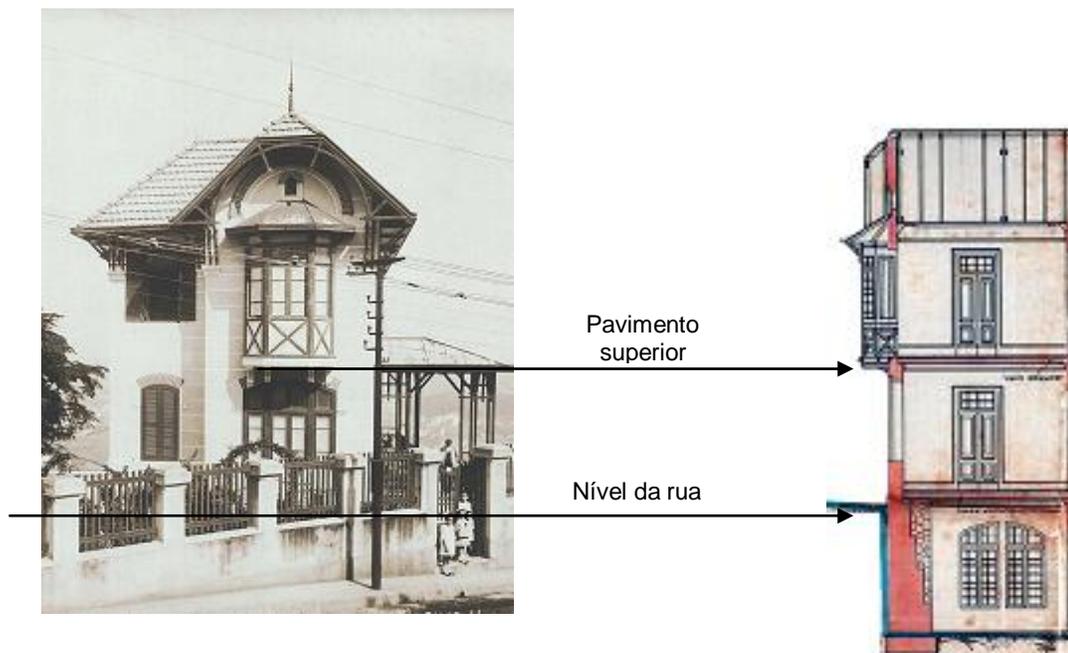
e 133: Os pavimentos que compõem a fachada principal.
